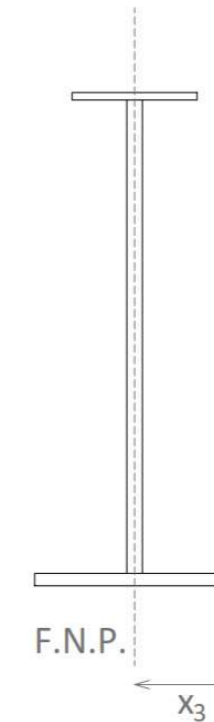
Fibra neutra plástica en la viga transversal para la flexión de eje vertical (fuente: elaboración propia)
